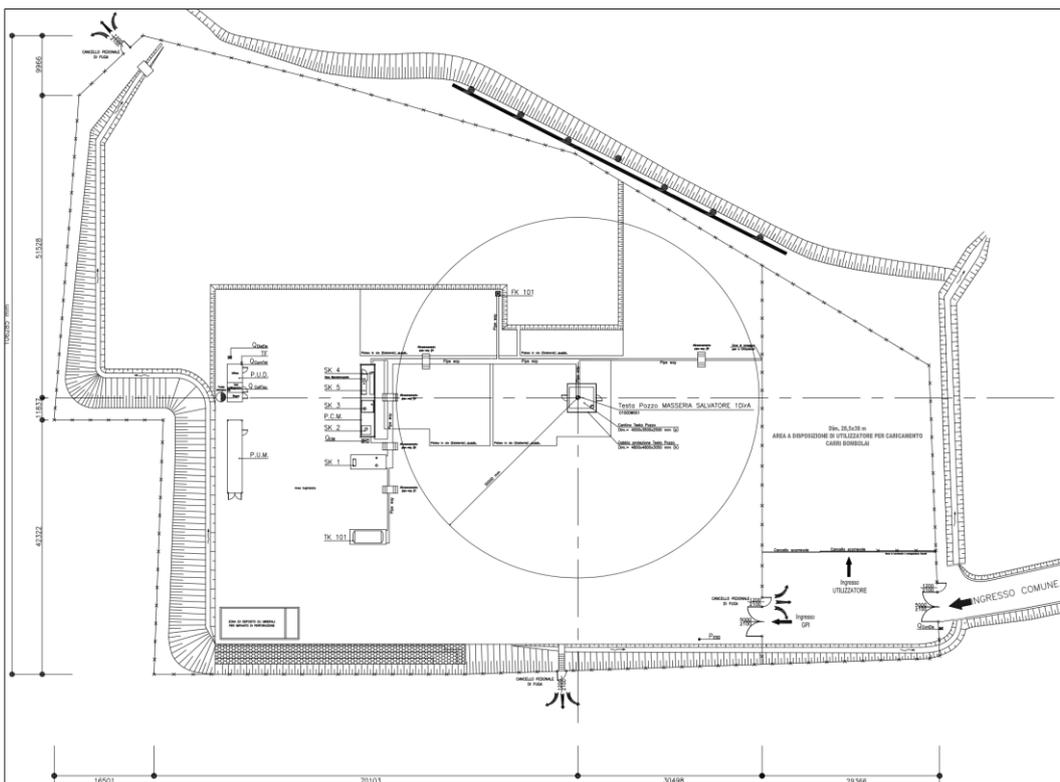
Layout dello stato di progetto con indicazione degli impianti in area mineraria.
